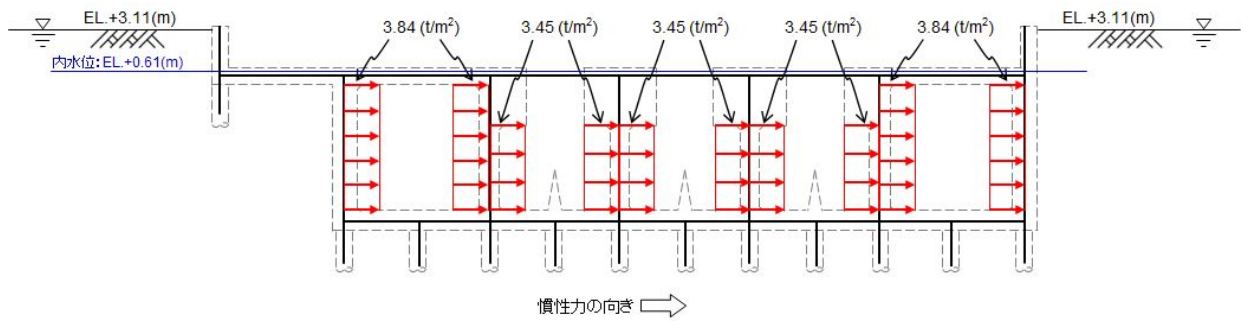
(1) 水平動による動水圧図（④-④断面）
